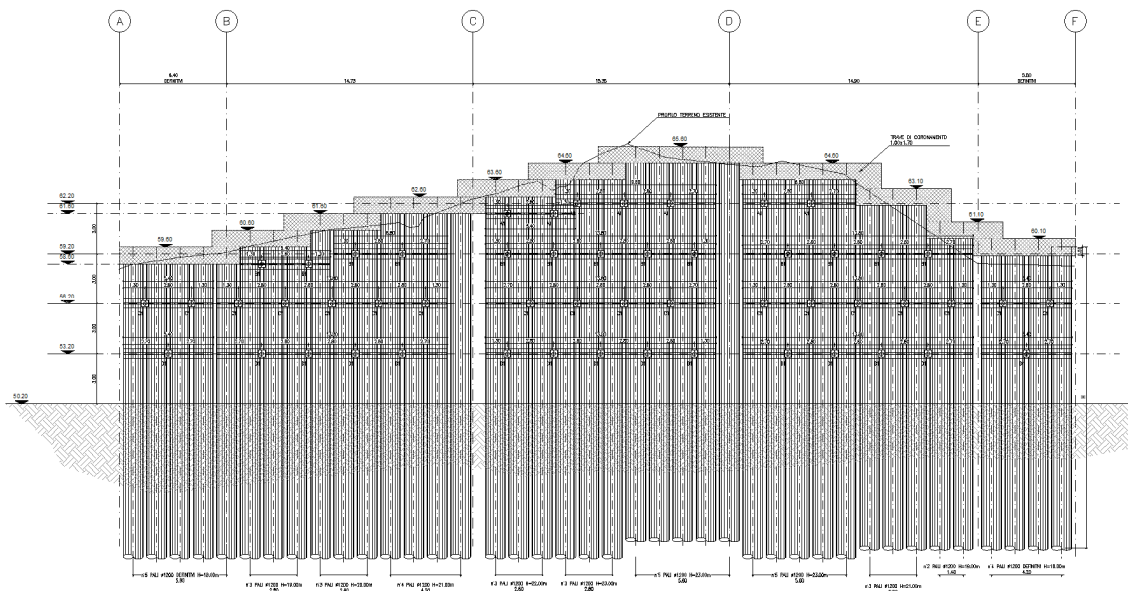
Prospetto paratia di pali Spalla SPB.
